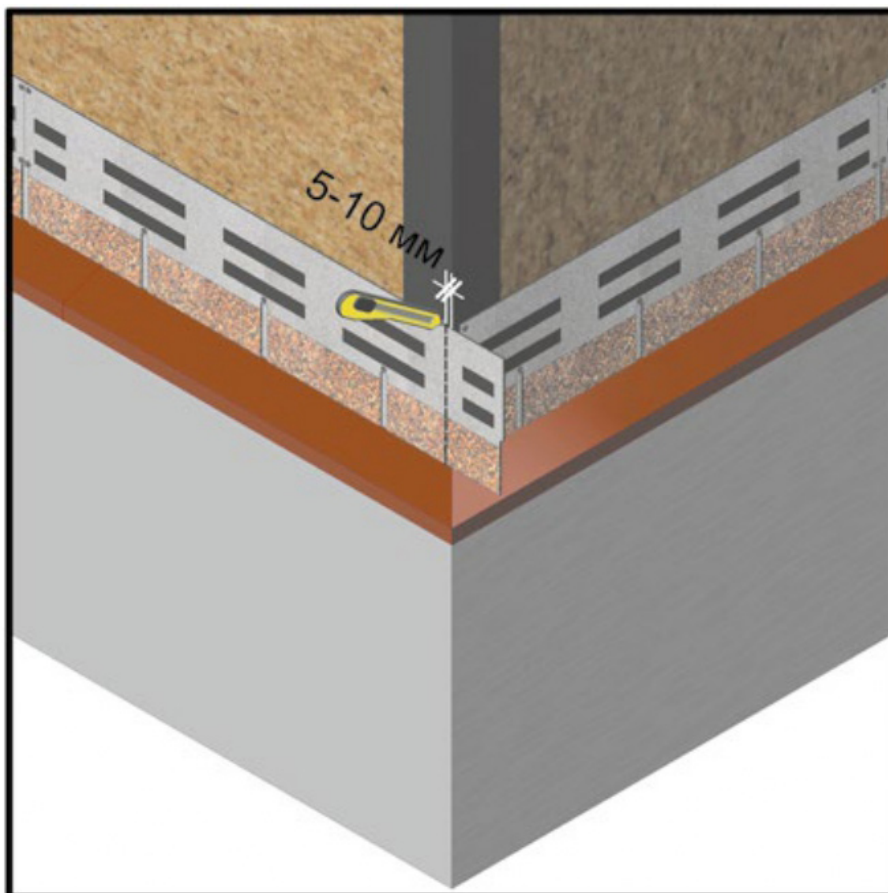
Подрезка фасадной плитки при подходе к углам.
